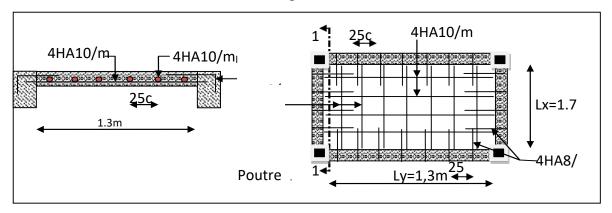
Schéma de ferraillage dalle pleine du locale machinerie III.8.3 Etude de la dalle pleine au-dessous de l'ascenseur :
